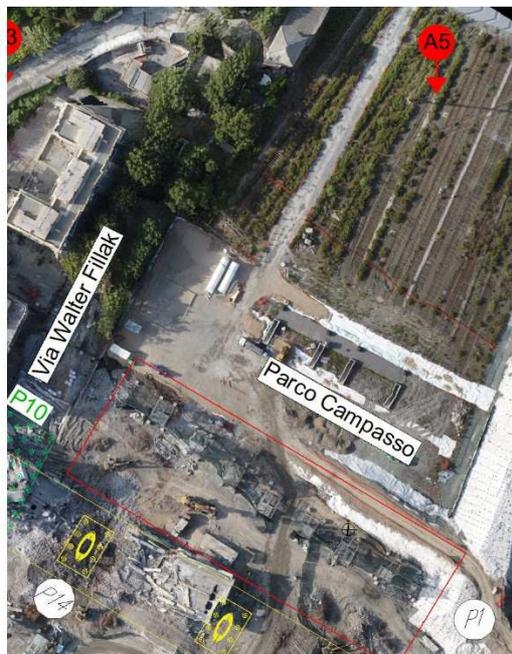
Postazione levante a Nord (44.425934 N, 8.890475 E) – PPN3 – A5
